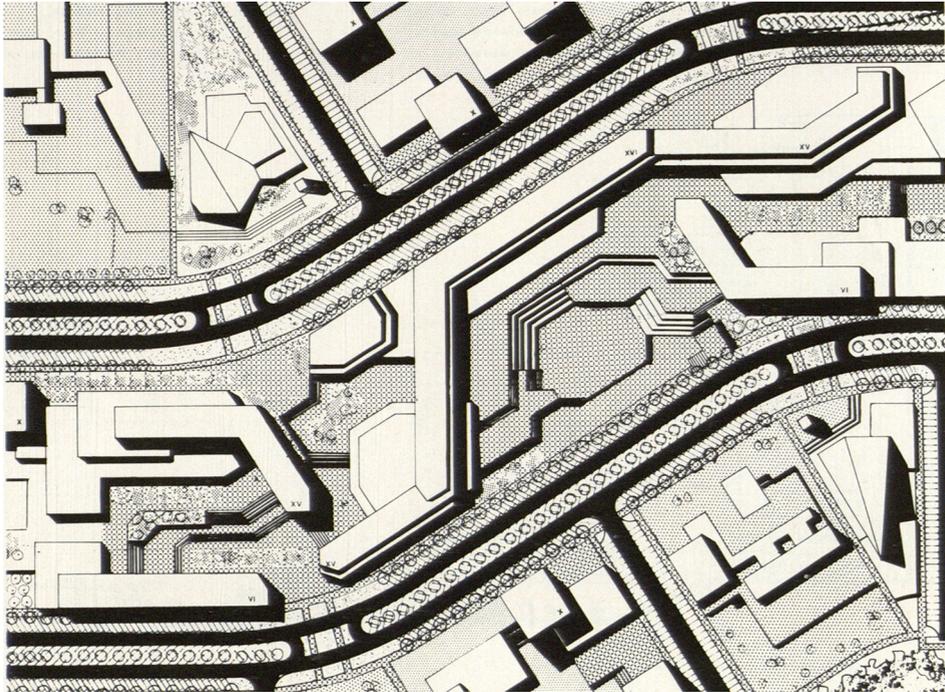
Plano general Plan Parcial Sardanyola. Fuente: «Revista Arquitectura», 94 pp. 43-48.
